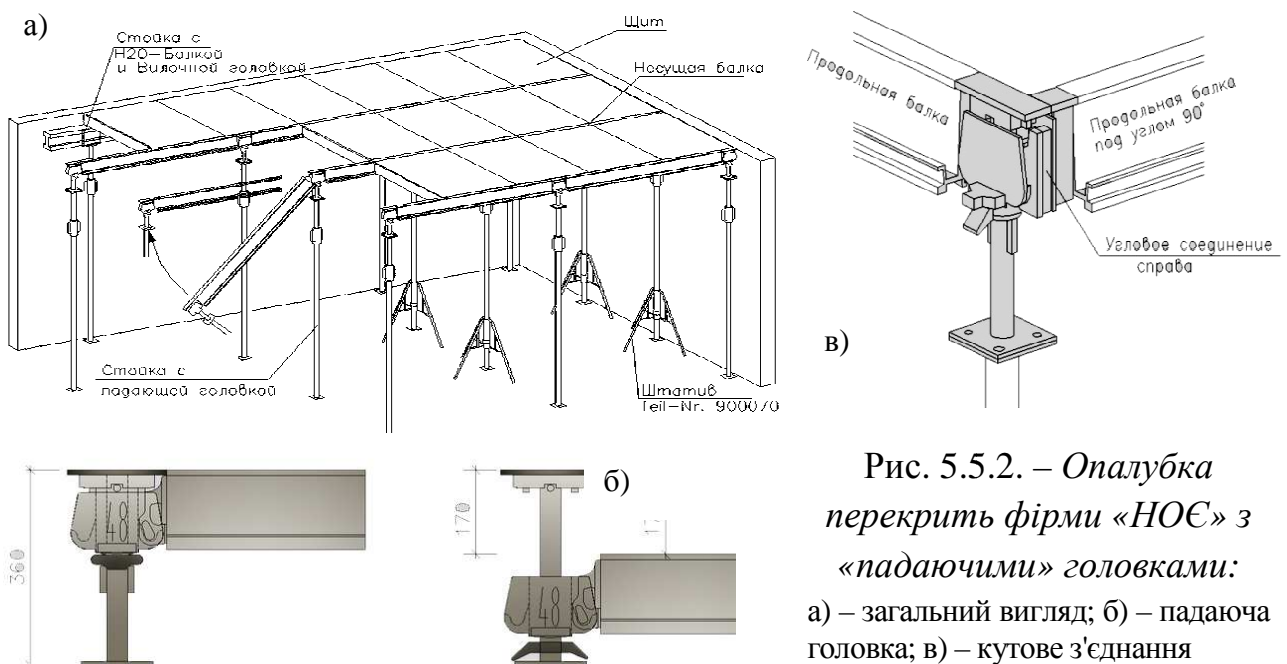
Опалубка перекриття фірми «НОС» з «падаючими» головками: а) – загальний вигляд; б) – падаюча головка; в) – кутове з'єднання
